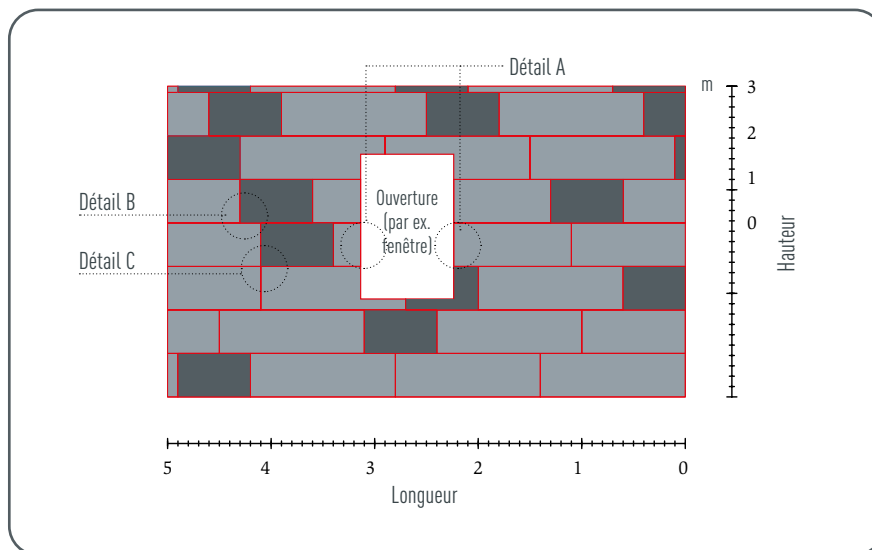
Panneau de façade FX.12 – Exemple de pose incorrecte
